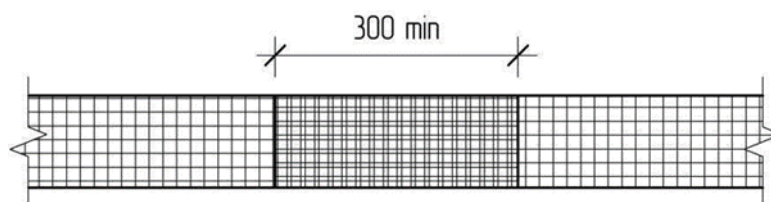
Схемы стыковки арматуры при горизонтальном армировании
